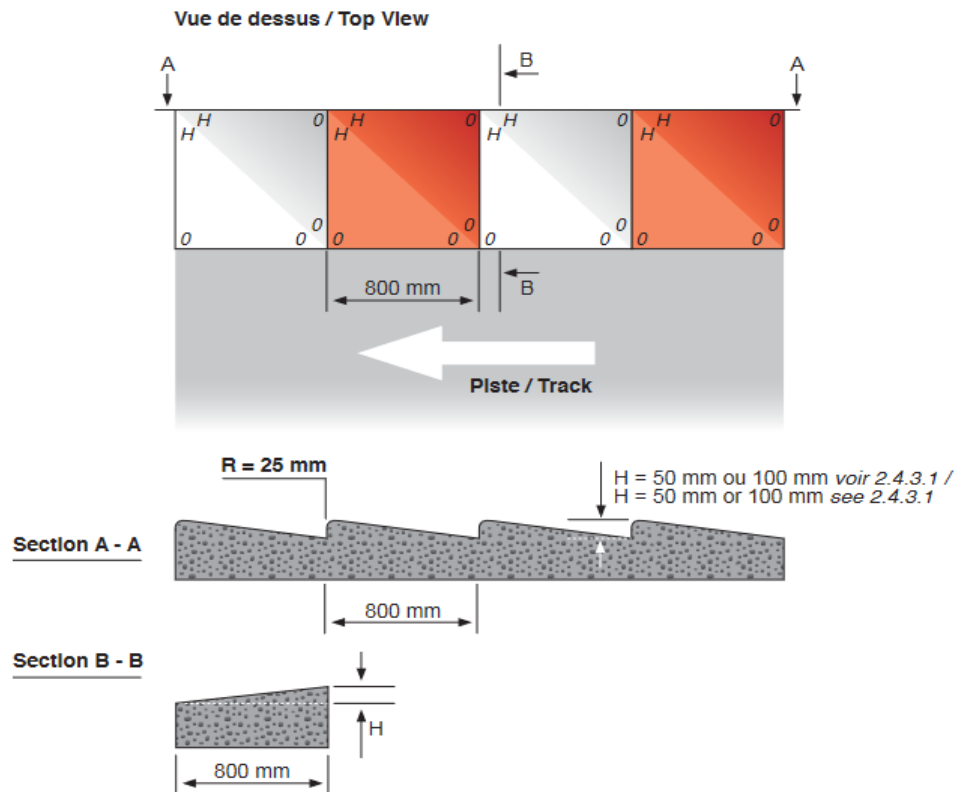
Plano de un plano de circuito, cortesía de (RFEA, 2018)
